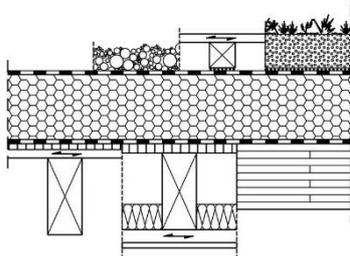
Typ I – Holzbalkenkonstruktion [3]
